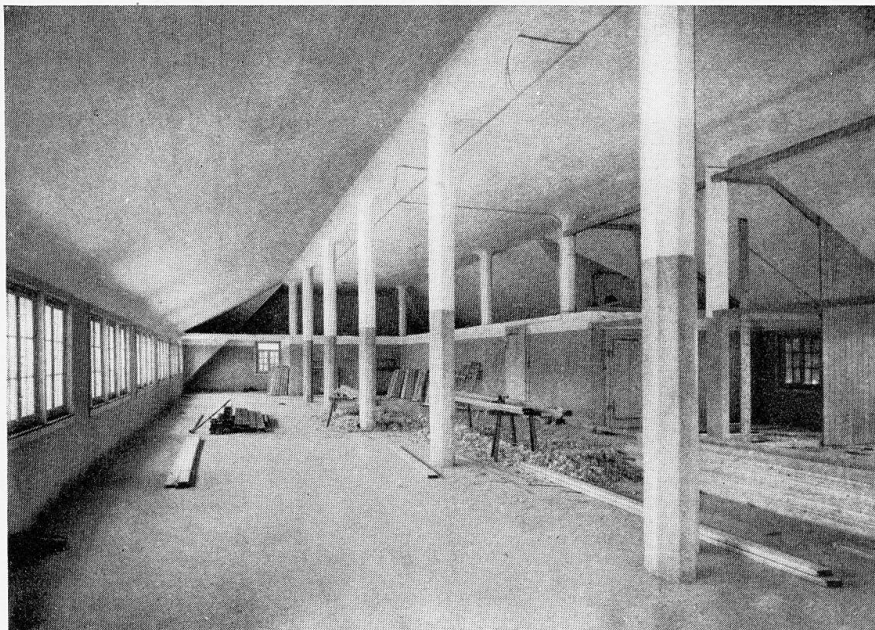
Nouveau bâtiment de la fabrique Felber et C^{ie}. Wädenswil.
